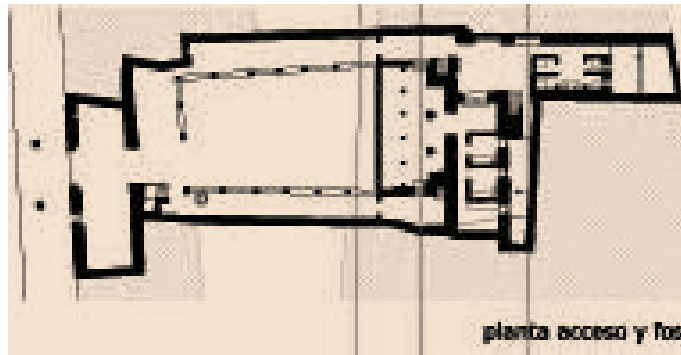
Planta arquitectónica Corral de Comedias de Almagro
